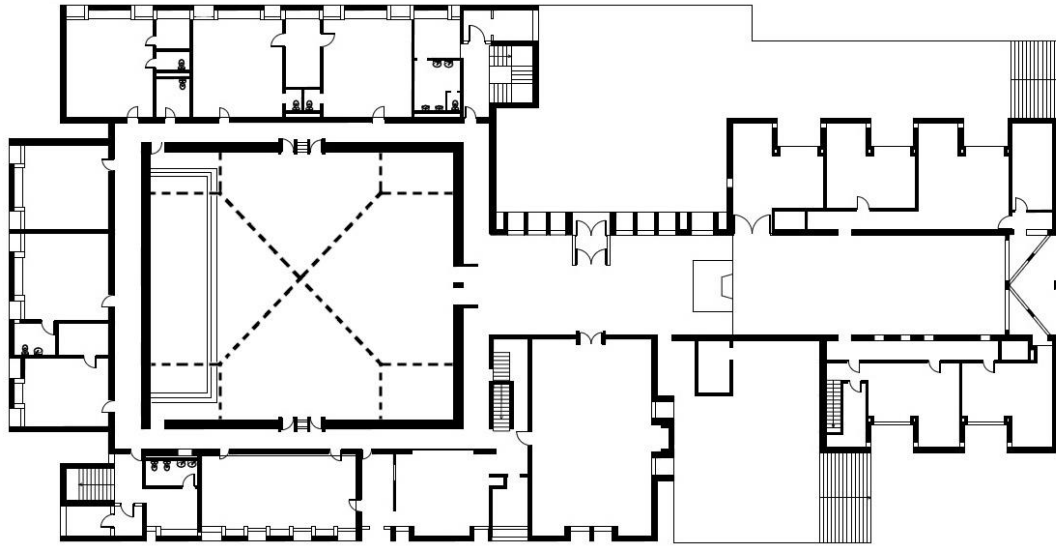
Louis I. Kahn - First Unitarian Church (Rochester, NY, 1959). Planta primera.
